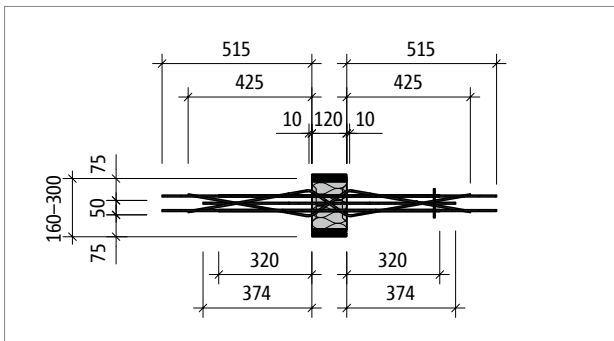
Schöck Isokorb® XT Typ WL-M1: Produktgrundriss
